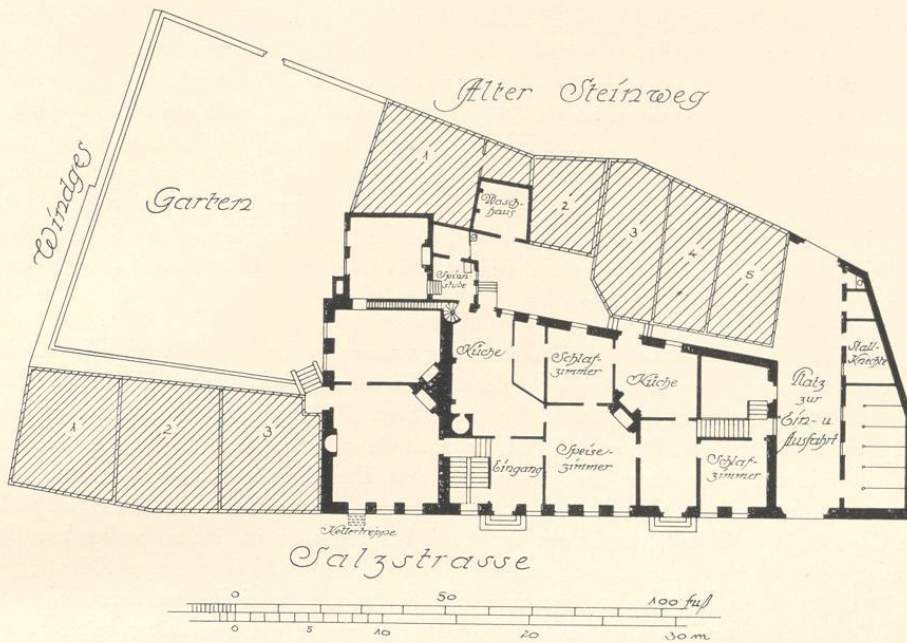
Grundriß des v. Wiedenbrücker Hofes, Salzstraße 18—21
